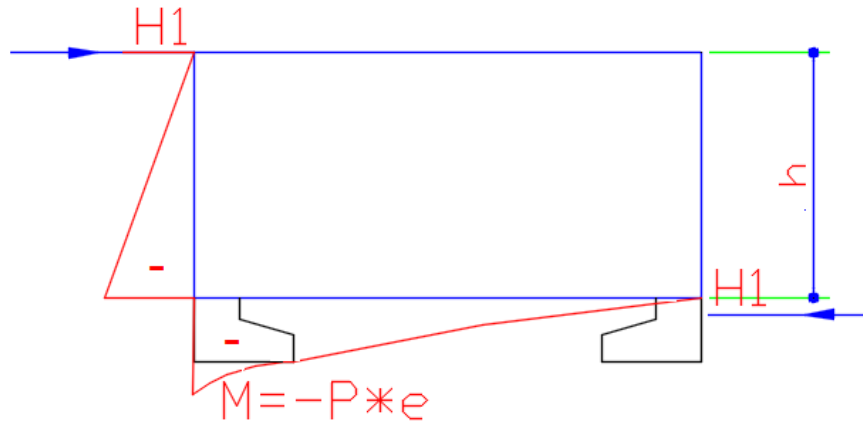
EXCENTREMENT EQUILIBRE PAR PLANCHER
